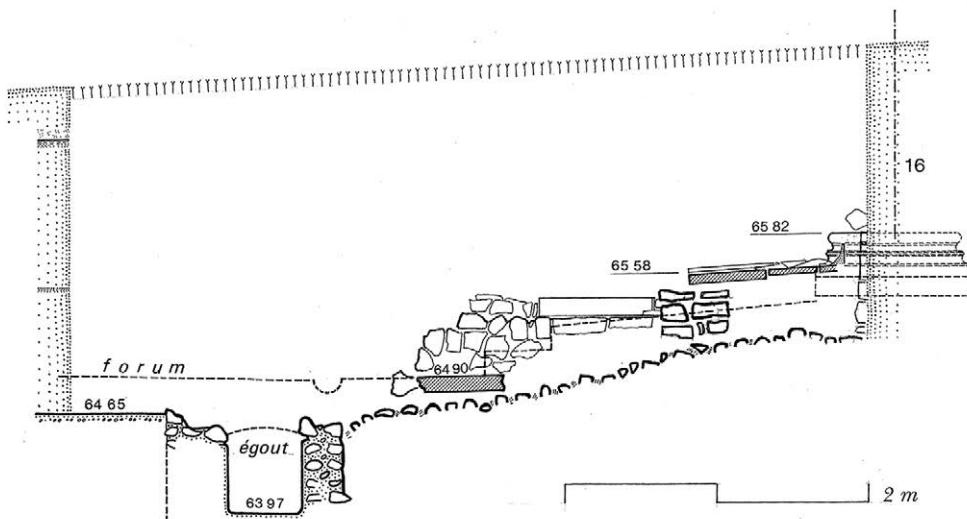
Coupe transversale en avant du portique sud, à l'ouest de la base 16 (G. Hallier).
